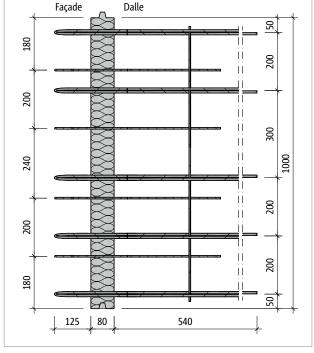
Schöck Rutherma® T type DF-V3-LR100 : vue en plan du produit
